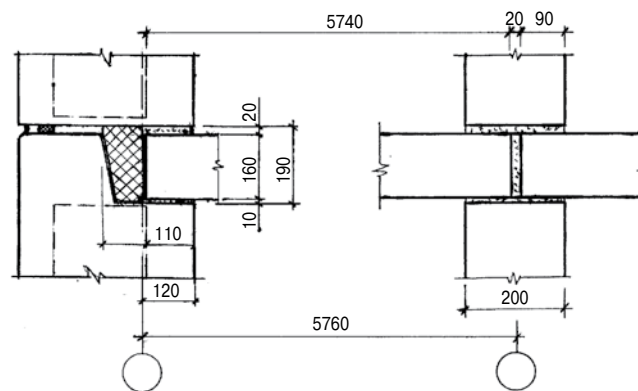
Пример измененной схемы опирания плит перекрытий на продольные стены
